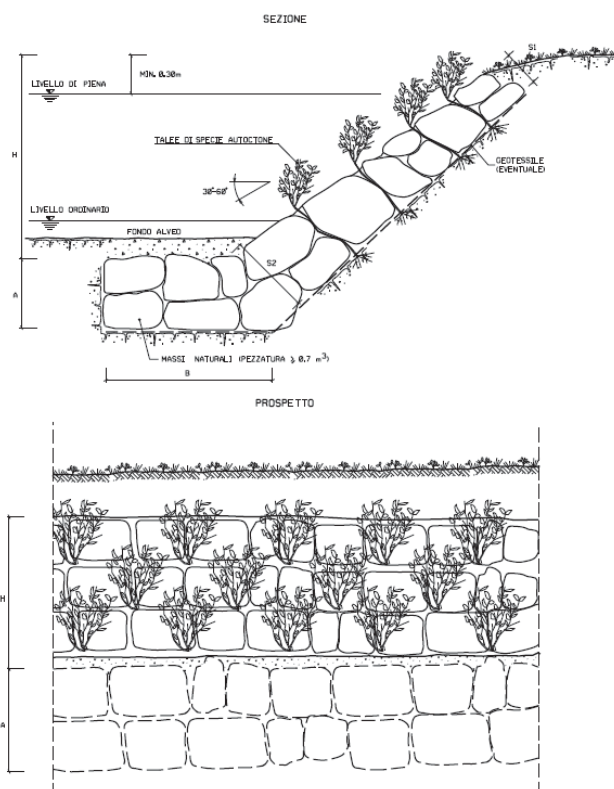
/A – Sezione trasversale e prospetto della scogliera in massi (disegno standard)
